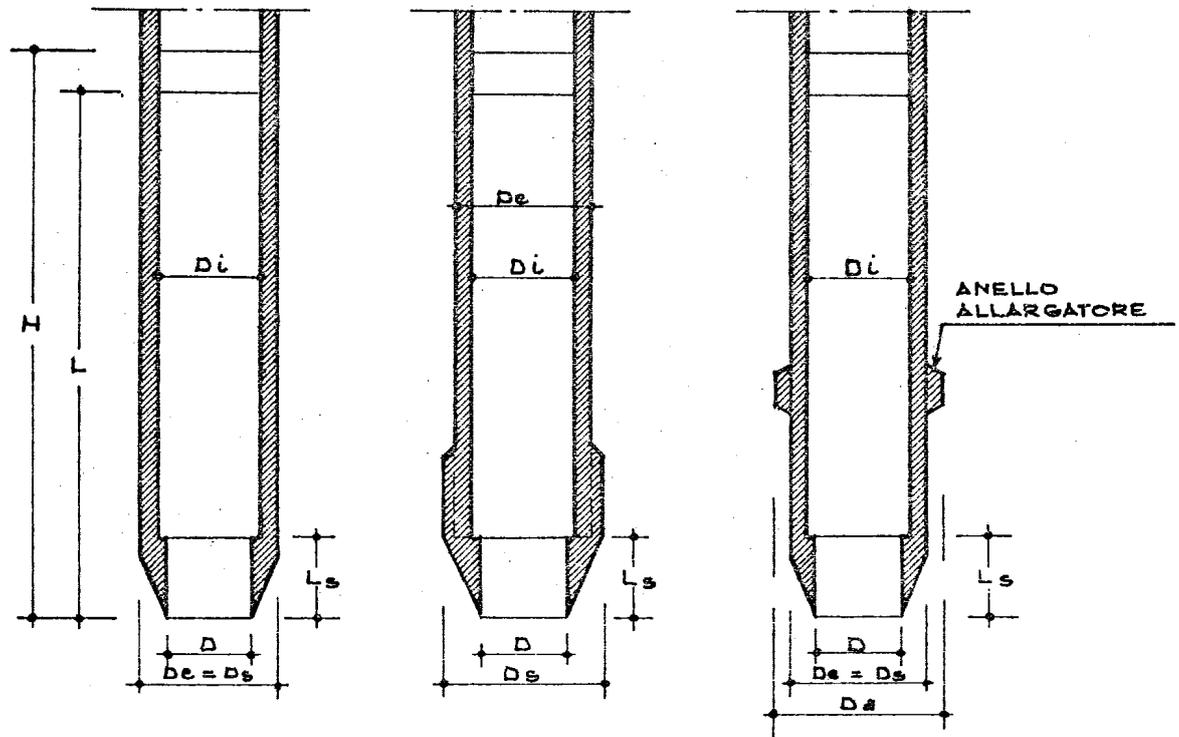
SCHEMA DI FUNZIONAMENTO DEL CAMPIONATORE A PARETI SOTTILI A PRESSIONE IDRAULICA
